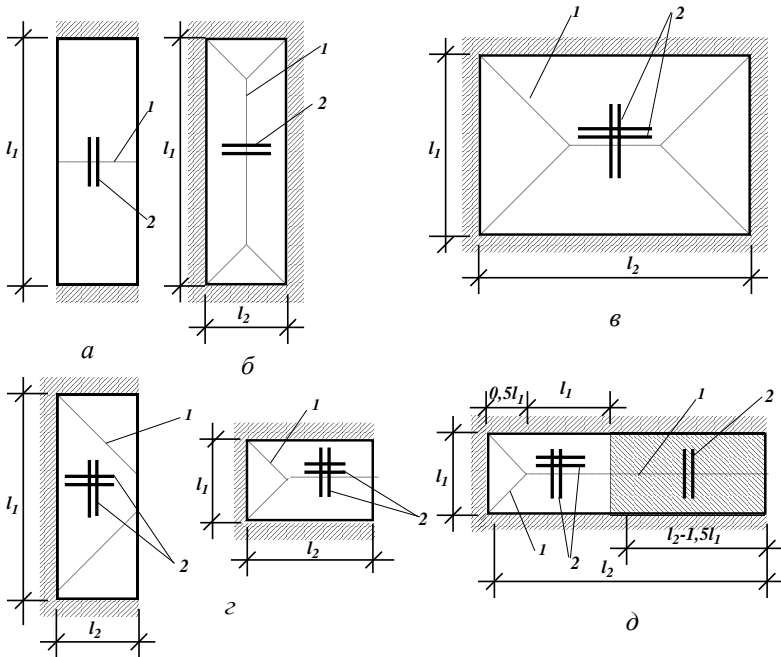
Схеми плит перекриттів: *a* – при опиранні на дві сторони; *б* – при опиранні на чотири сторони і роботі в напрямі l_1 , ($l_2/l_1 \geq 3$); *в* – те саме, при роботі в двох напрямках ($l_2/l_1 < 3$); *г* – при опиранні на три сторони ($l_2/l_1 < 1,5$); *д* – те саме, при $l_2/l_1 > 1,5$; 1 – лінії зламу; 2 – робоча арматура
